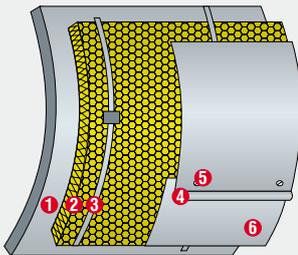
1. Стенка резервуара, 2. Изоляция из маты ROCKMATA, 3. Крепящий бандаж, 4. Канавки, обеспечивающие вентиляцию, 5. Саморезы либо заклепки, 6. Защитный кожух из жести.
